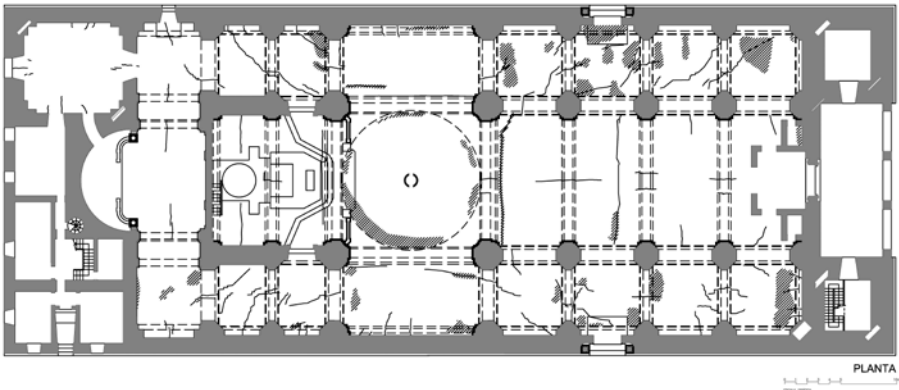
Plano de humedades y grietas del templo en 1995. Fuente: propia a partir de Proyecto de Joaquín López Davó.
